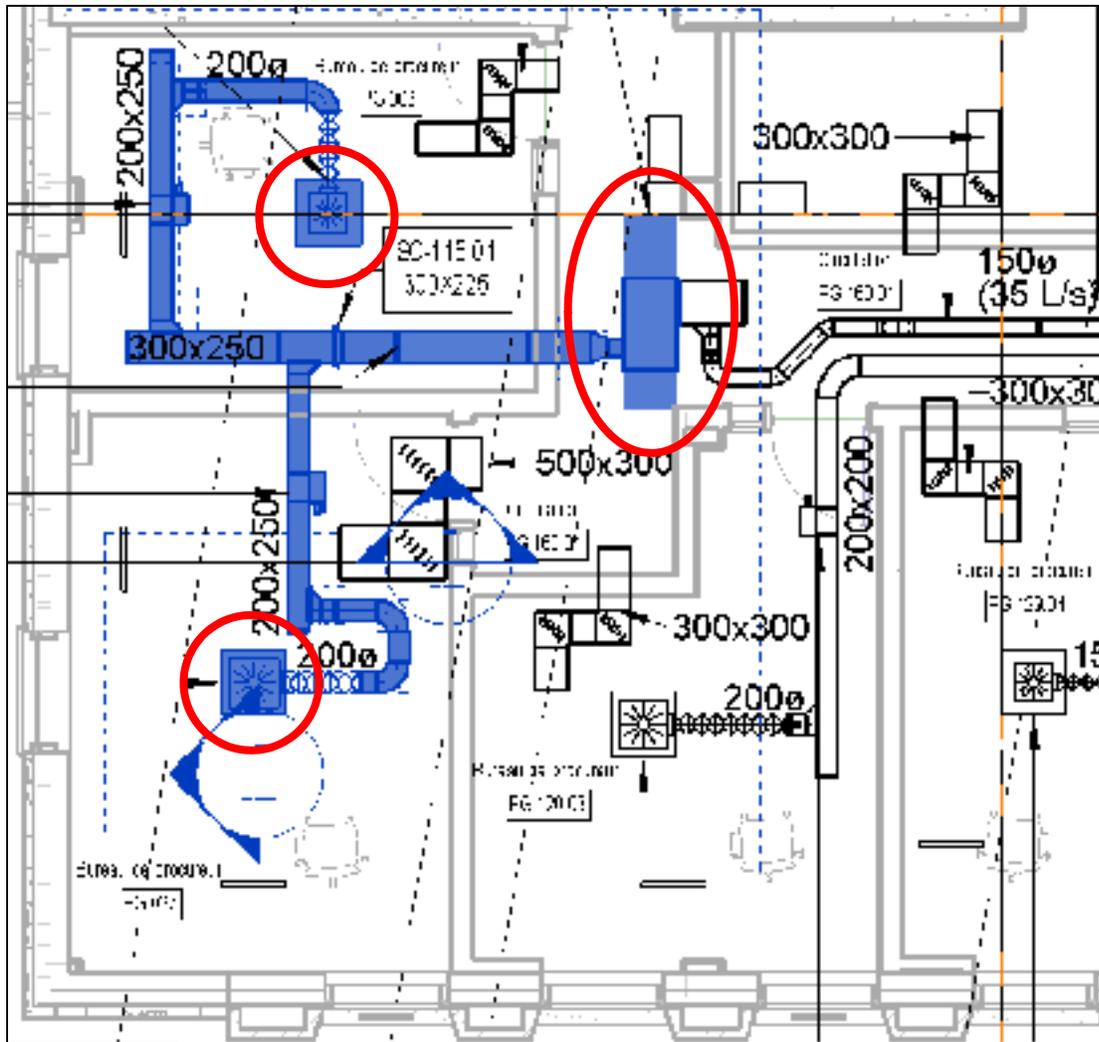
Extrait de plan Revit® mettant en avant le système de ventilation de deux bureaux
